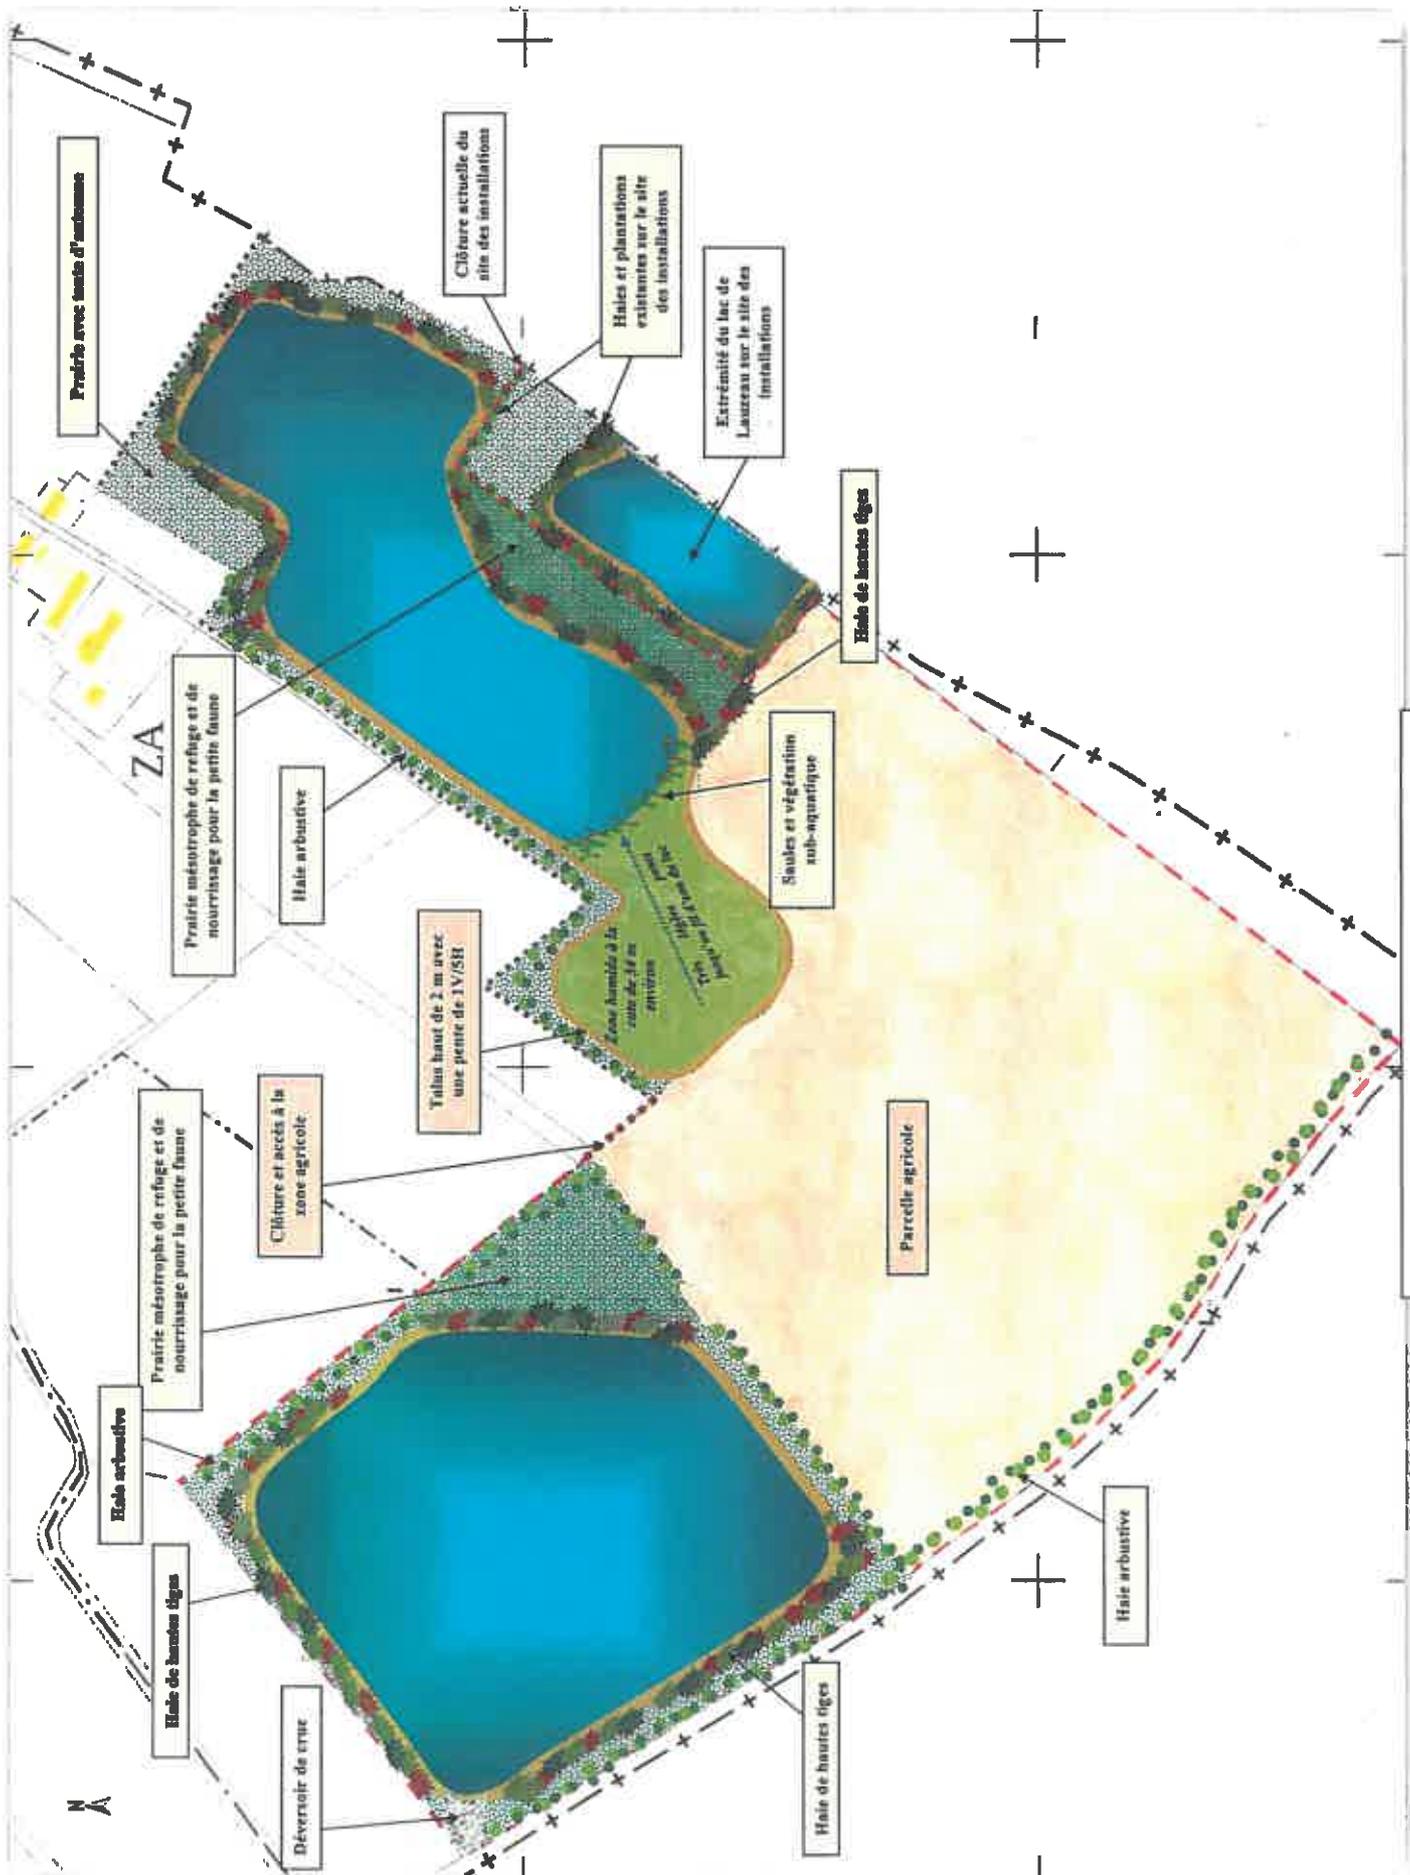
Plan de remise en état (Fond à l'échelle 1/500)
